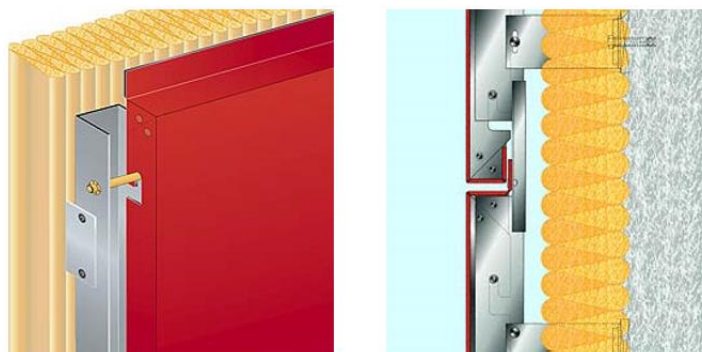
Sistema de encaixe para cassettes [6]
